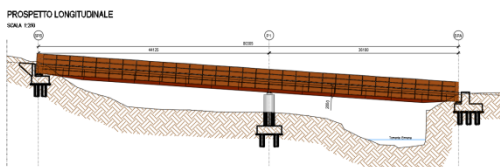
Sezione longitudinale ponte sull' Ermena (Estratto dalla tavola di progetto P00VI02STRPF01_A)
